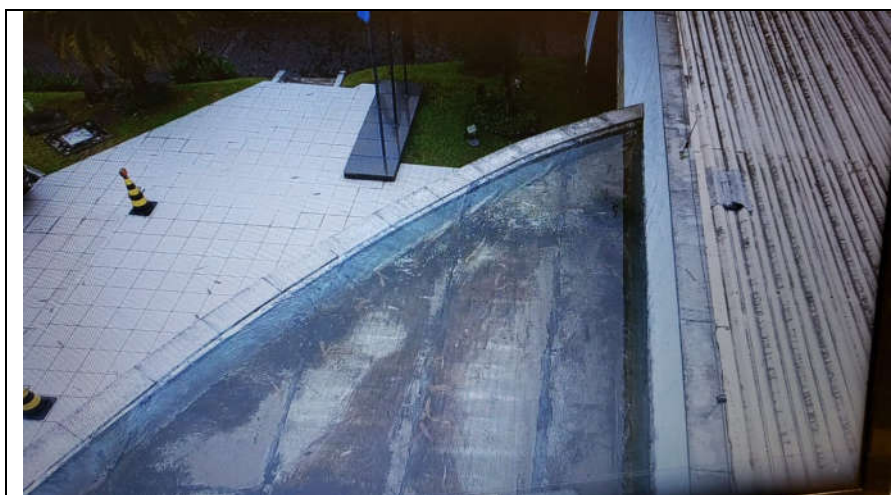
Laje descoberta a ser impermeabilizada (fachada principal)
